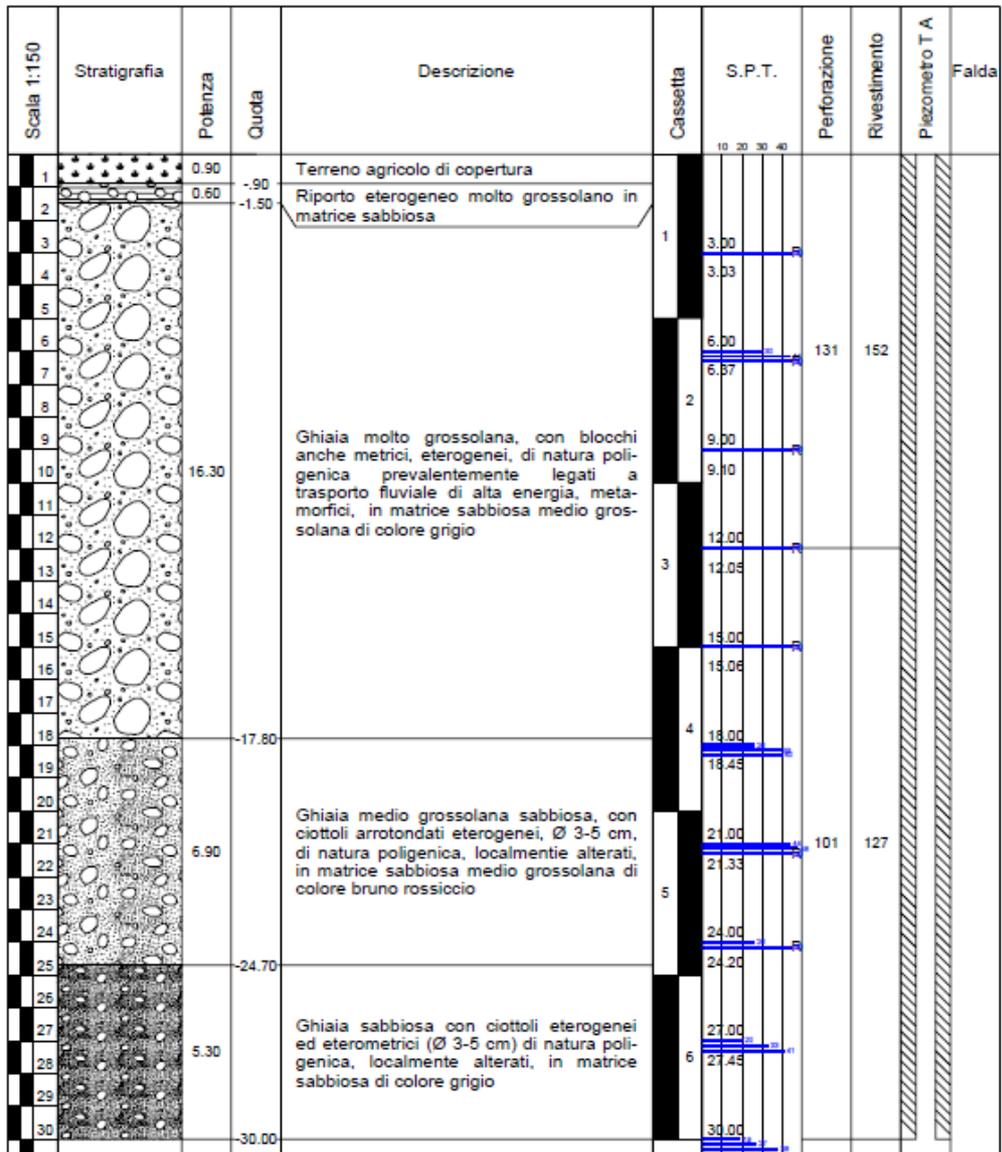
Sondaggio eseguito dalla ditta Somiter presso il cantiere di Piazza Piave.
